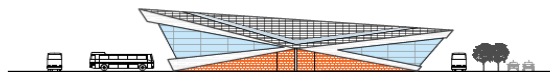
Planta arquitectónica (edificio) Propuesta terminal Pujilí
